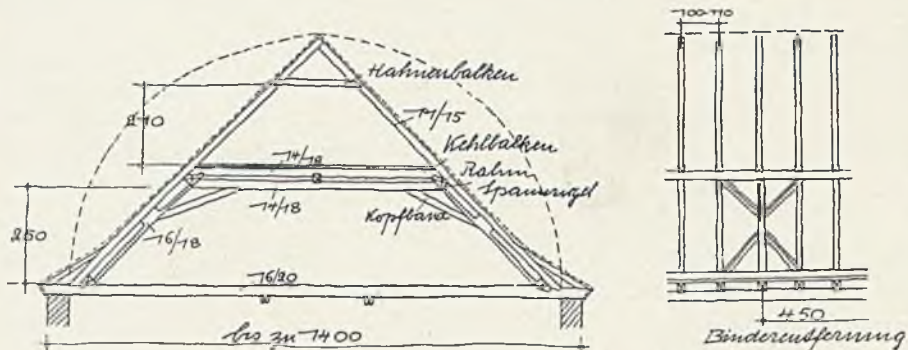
Kehlbalkendach mit liegendem Stuhl und Hahnenbalken
